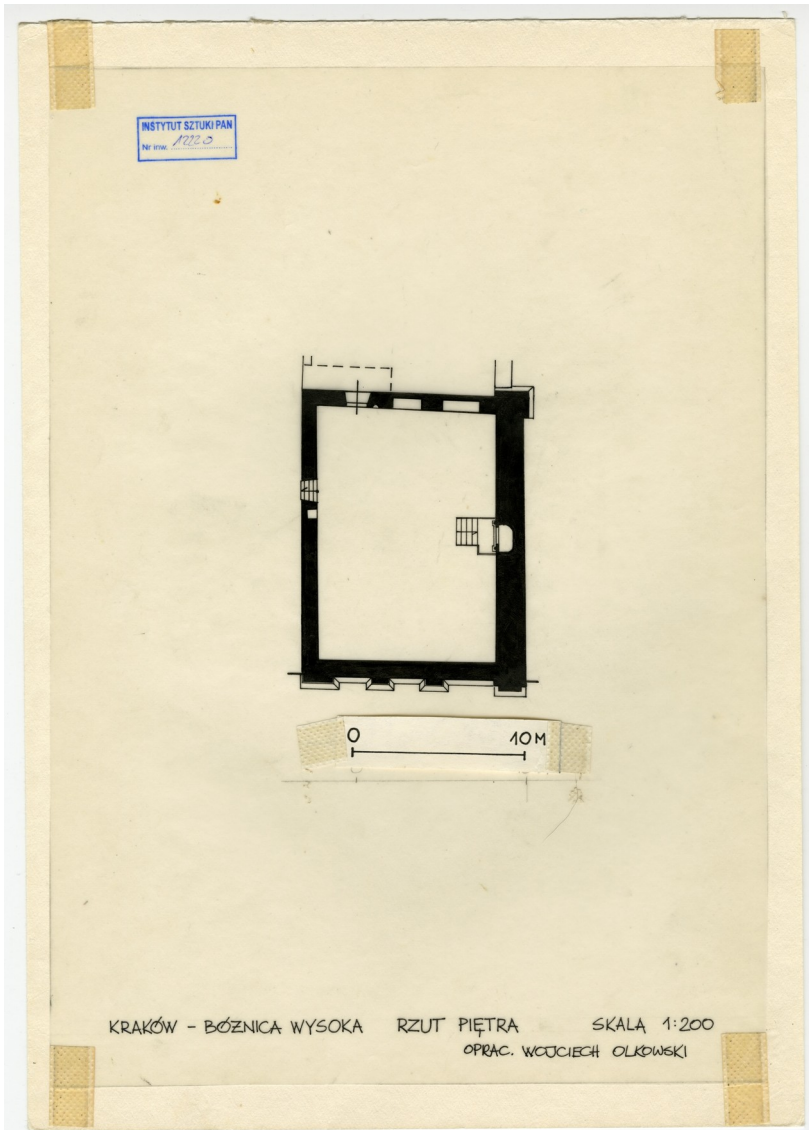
Grundriss OG, 1960er Jahre
